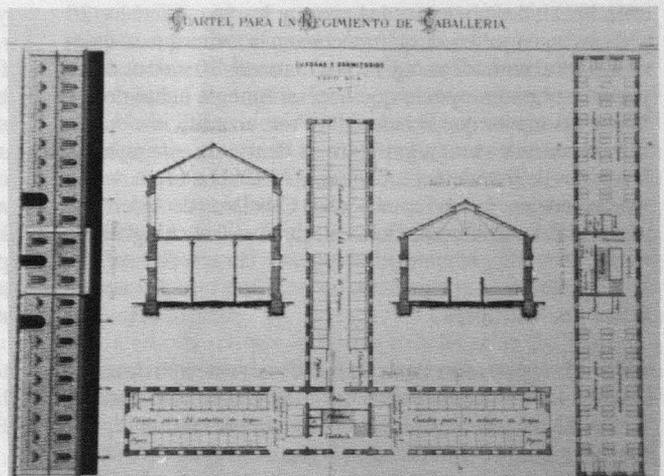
Cuartel para un regimiento de Caballería: planta dispuesta en T, alzado y secciones de cuadras y dormitorios. (Cuarteles Tipos, 1892, Lám. 79).
